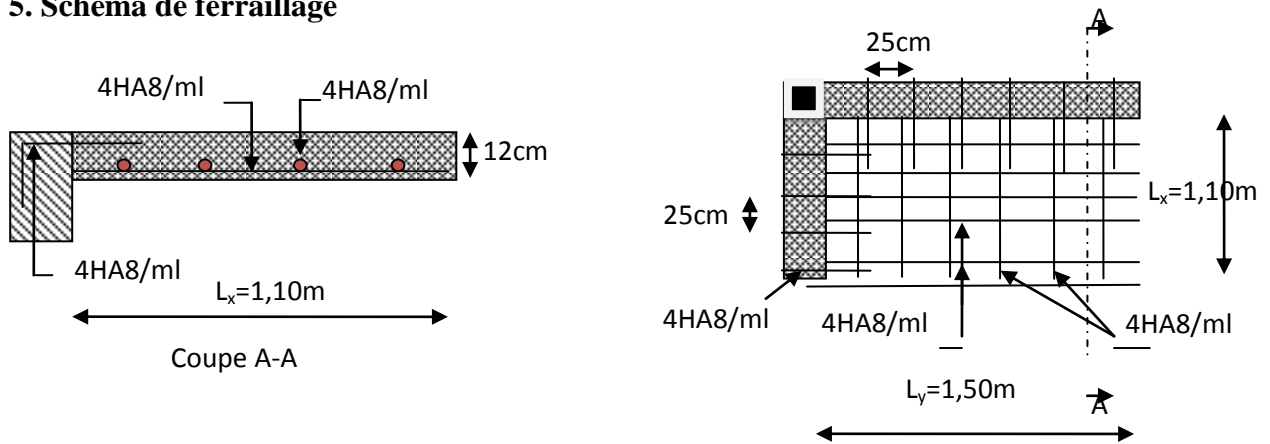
Schéma du ferrailage du panneau de dalle sur 2 appuis
